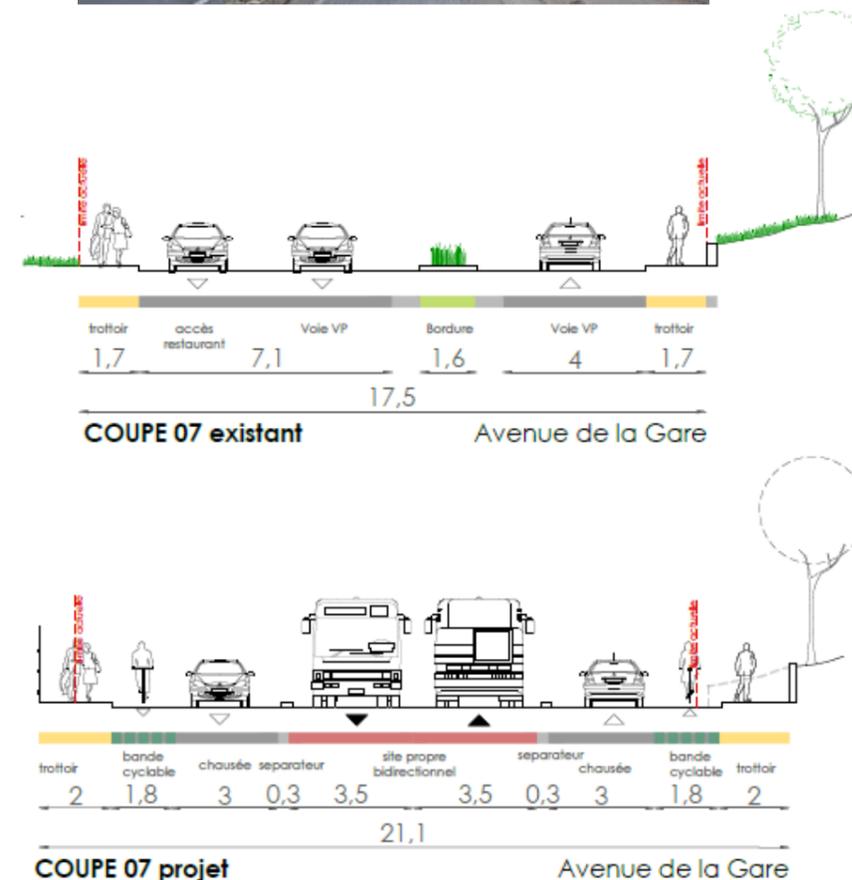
Profil existant et projeté sur l'avenue de la Gare
